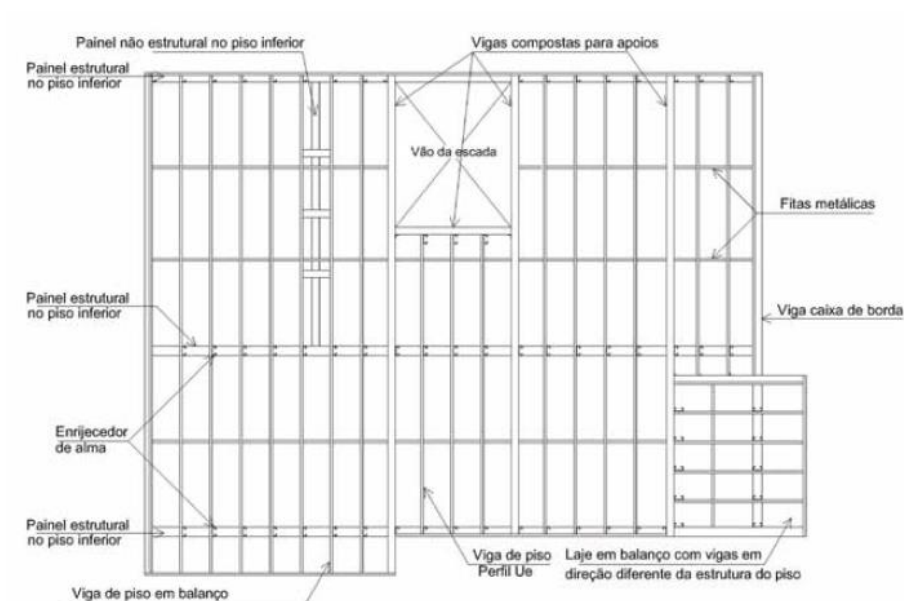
Estrutura de piso em *Light Steel Framing*.
